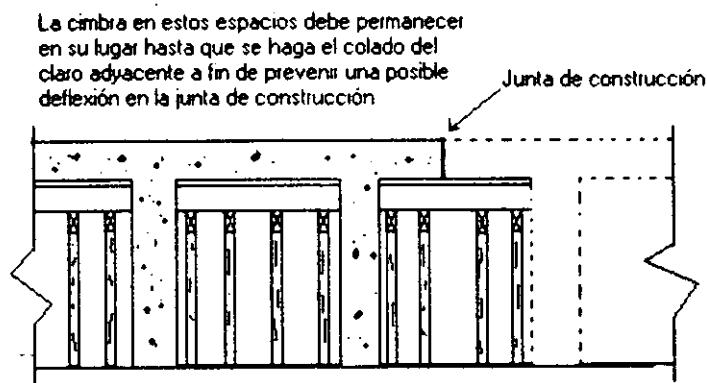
Cimbrado y apuntalamiento que soportan losas en las juntas de construcción.
